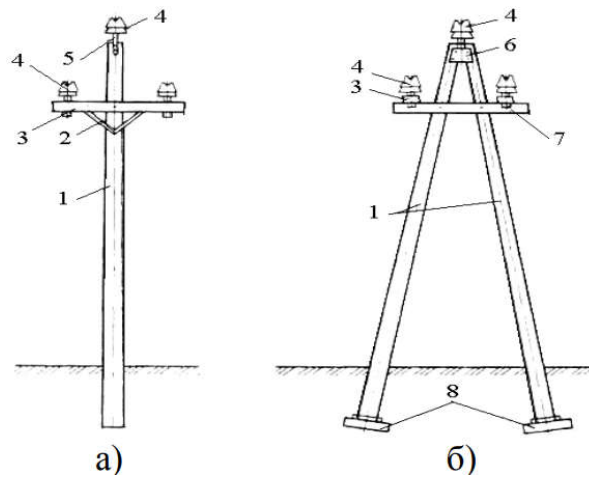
Залізобетонні опори ПЛ на напругу 6-10 кВ із центрофугованих стійок: а) проміжна; б) анкерна; 1 - стійка; 2 - розкоси; 3 - траверси; 4 - ізолятори; 5 - верхівковий штир; 6 - металева пластина; 7 - підтраверсники; 8 - анкерно-опорні плити.
